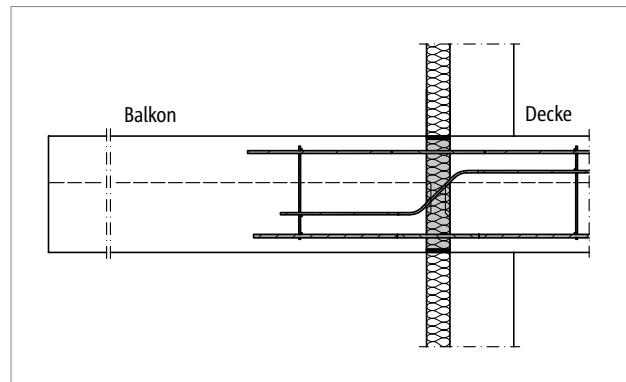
Schöck Isokorb® T Typ BP: Balkonkonstruktion mit frei auskragenden Unterzügen
